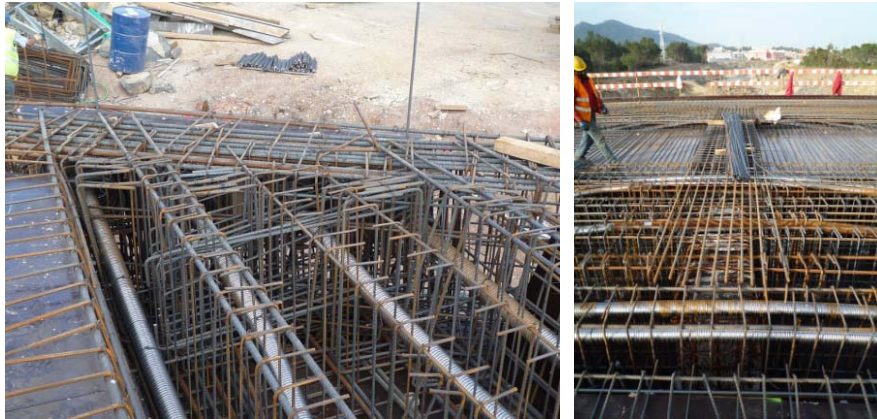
e 92: Bainhas de pré-esforço junto aos encontros e pilares
